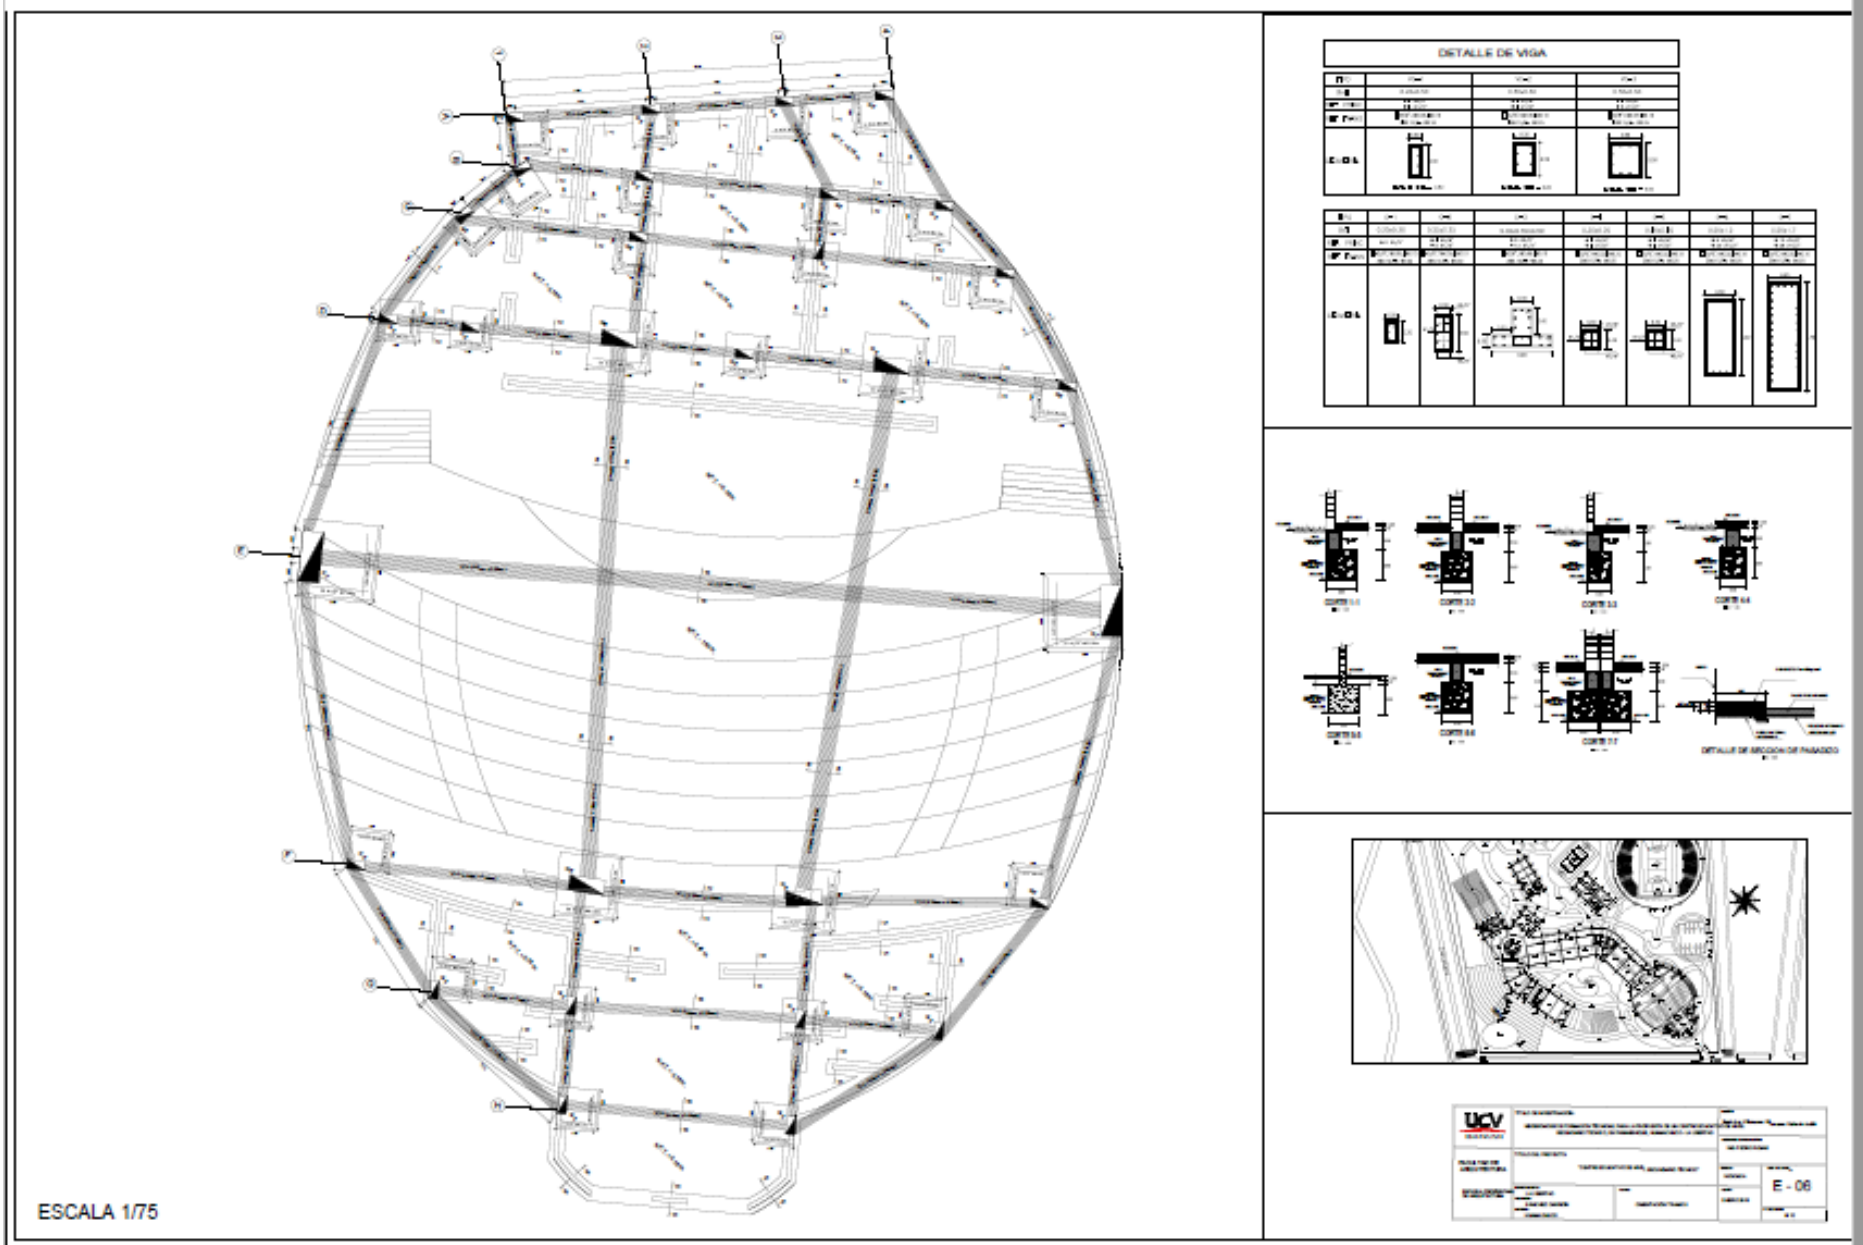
Plano Diseño Estructural Bloque 05 – Cimentación- Plano N° 14 - Lamina E-06
